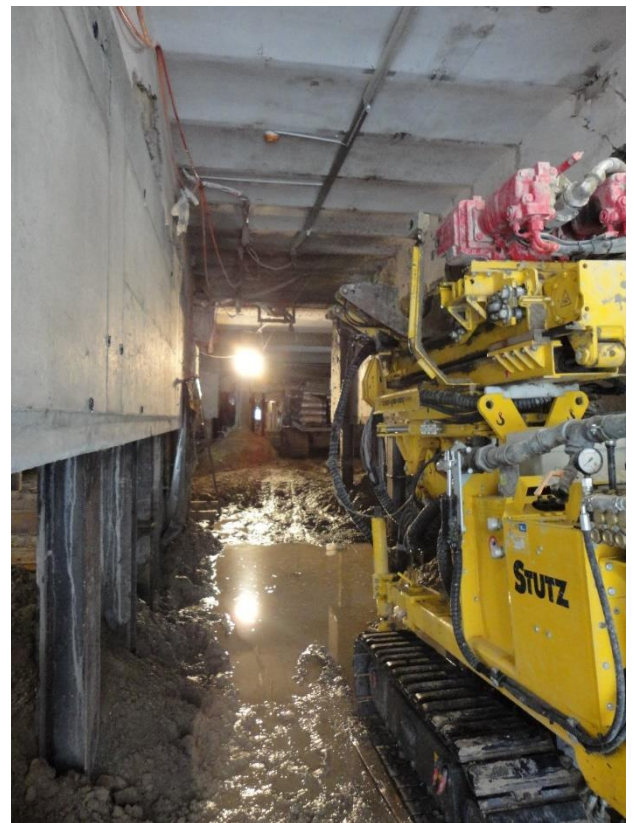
, MFO sótano, maquinaria, forjado con bóveda Fuente: Archivo, Archobau dirección de obra
